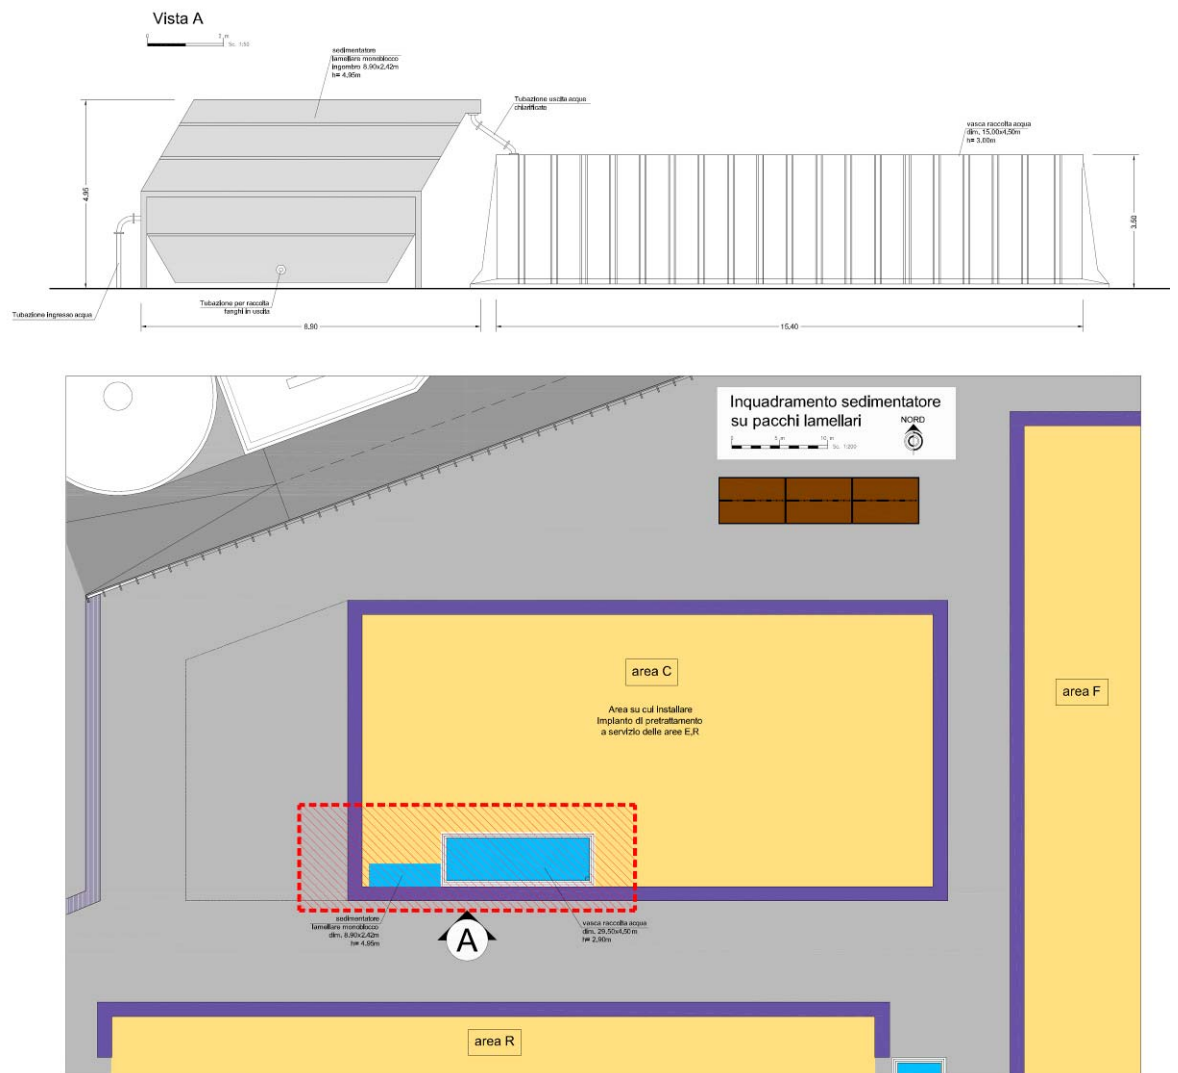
Ubicazione e sezione impianto a pacchi lamellari.
